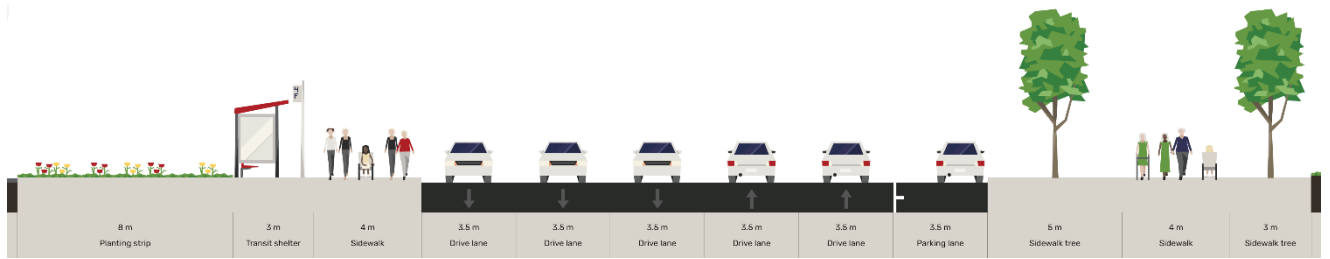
Типовий поперечний профіль вулиці Сверстюка (Розріз 2-2)
